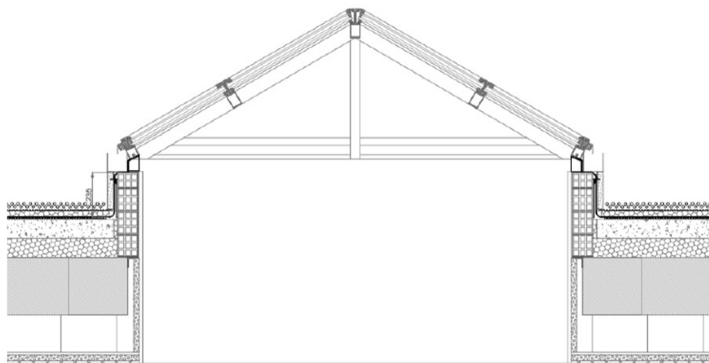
Detalle perfil lucernario. Fuente: Elaboración propia.
